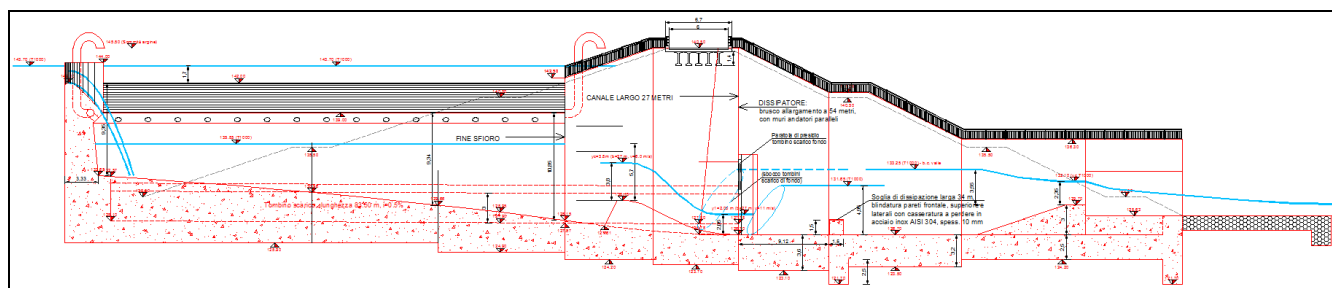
Manufatto C: sezione longitudinale.
